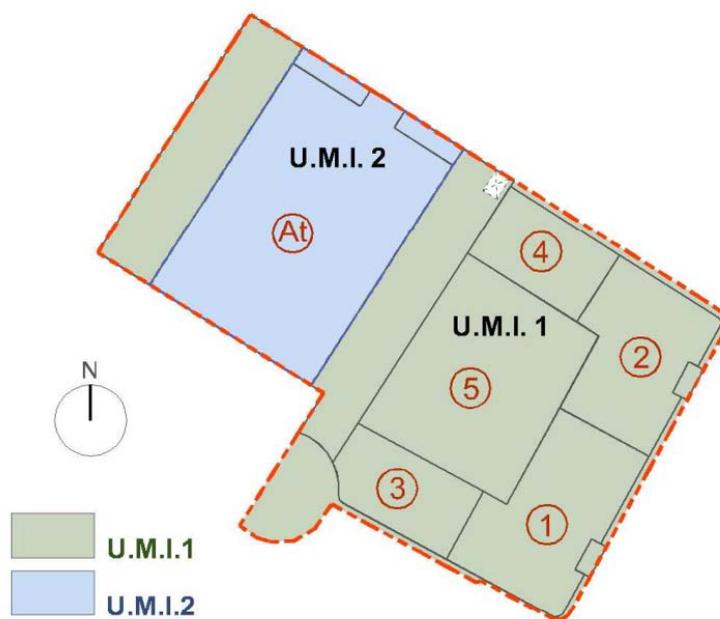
Estratto Tav C7 Planivolumetrico (Fonte: Elaborati del P.A.)
